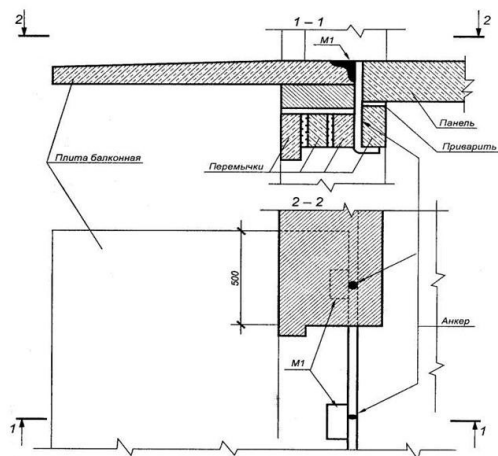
Крепление балконной плиты в стене кирпичной кладки
